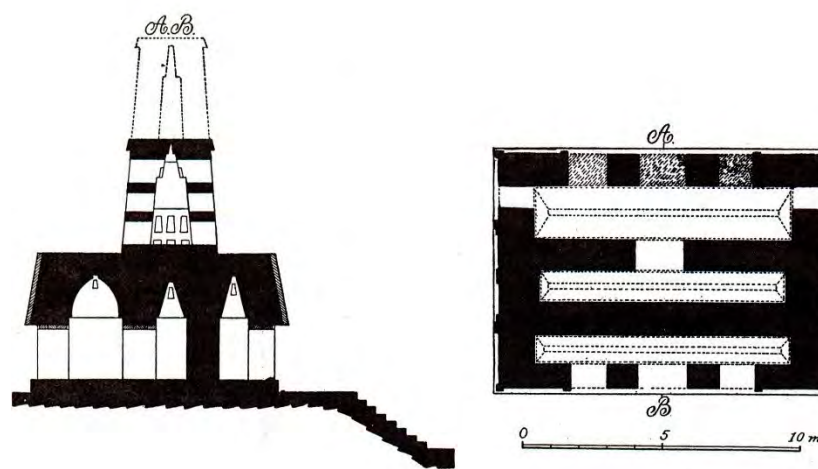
Corte y planta arquitectónica del Edificio 6.
